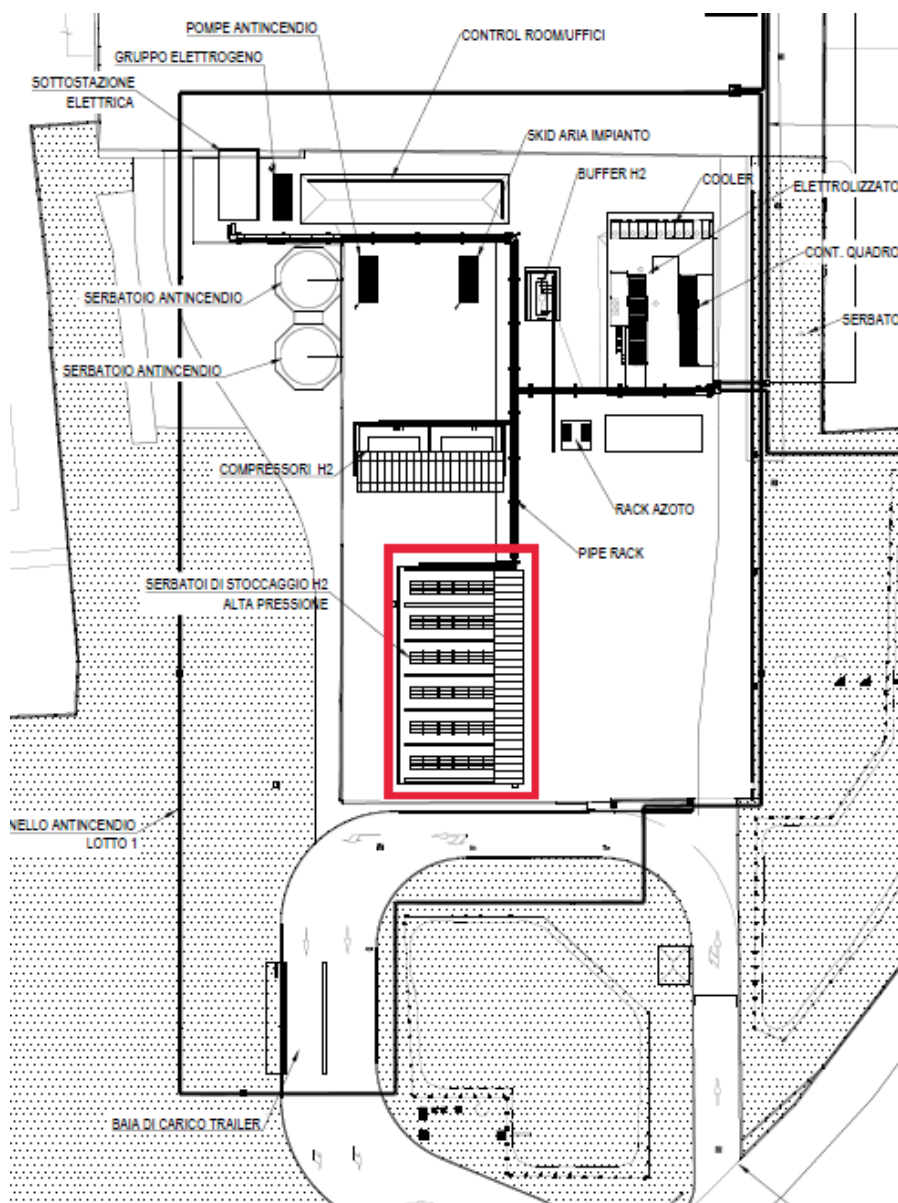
Individuazione planimetrica delle unità di stoccaggio nel Lotto 1
